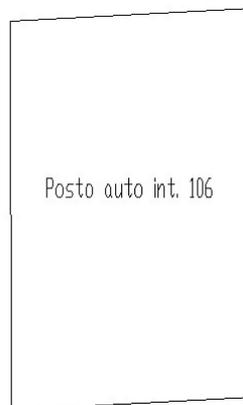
Planimetria del garage n.106 oggetto di pignoramento
